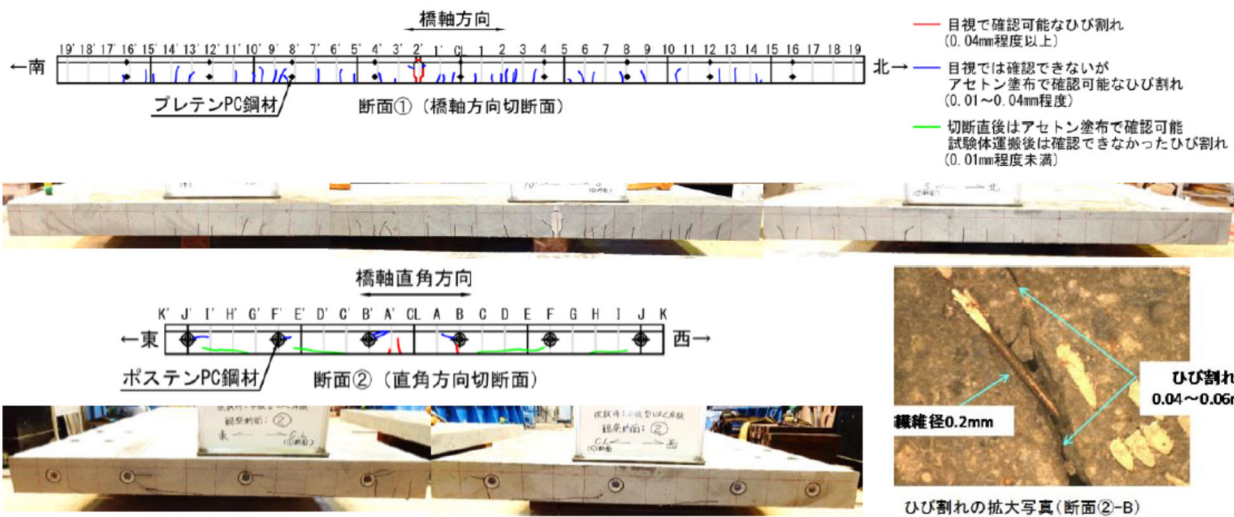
ひび割れ図 (切断面)
